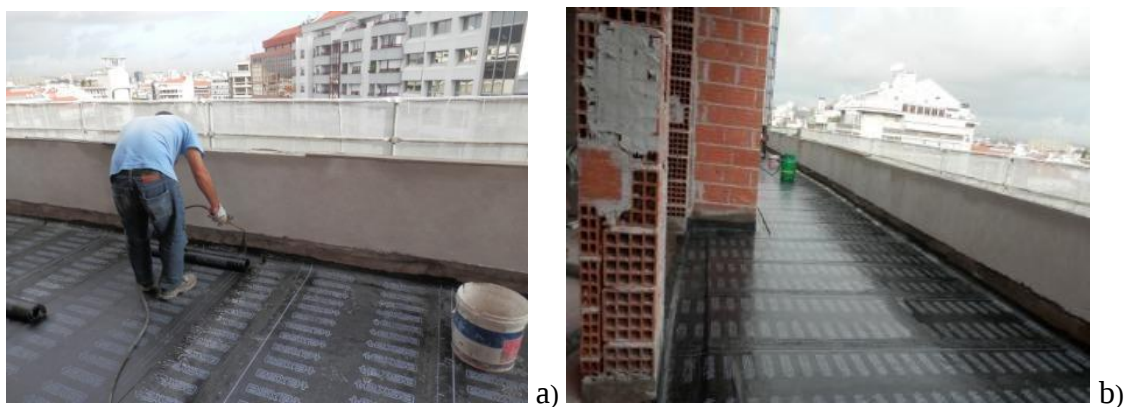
Fases da aplicação da tela betuminosa: a) aplicação de tela betuminosa após a colocação do XPS; b) conclusão da impermeabilização
